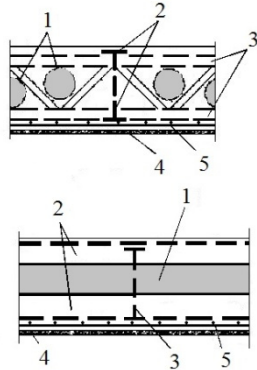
Схема фиксации вкладышей в облегченном перекрытии: 1 – вкладыши; 2 и 3 – главные и второстепенные металлические сквозные балки; 4 – опалубка; 5 – арматурная сетка
